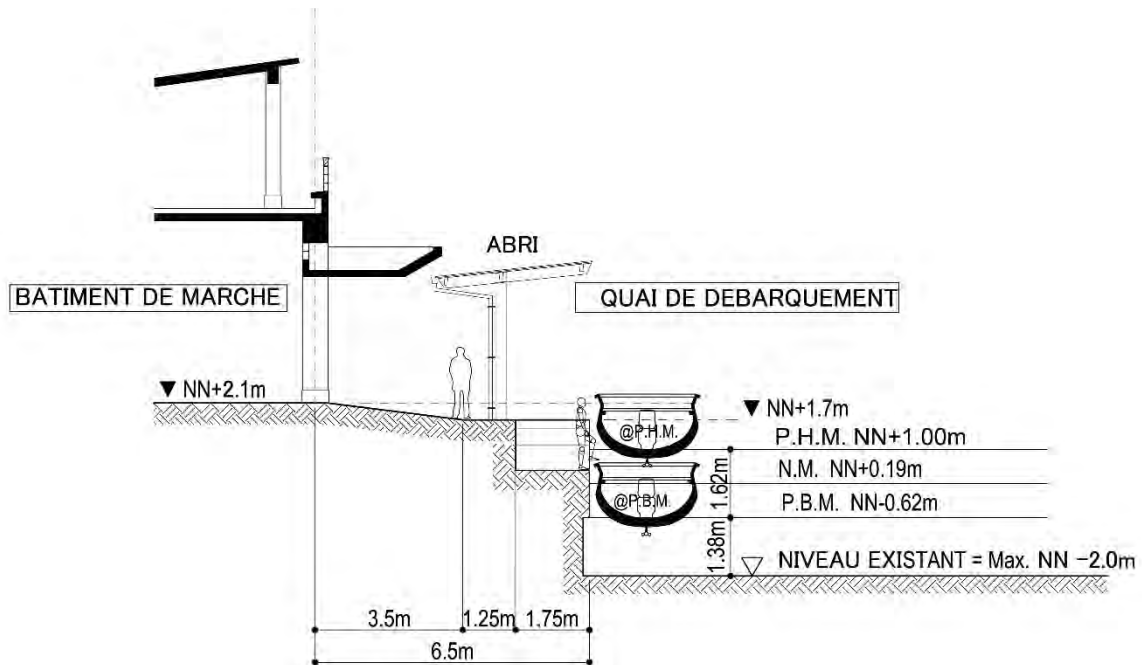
Hauteur de plancher en coupe du quai renforcé (quai de débarquement) au bâtiment de marché
